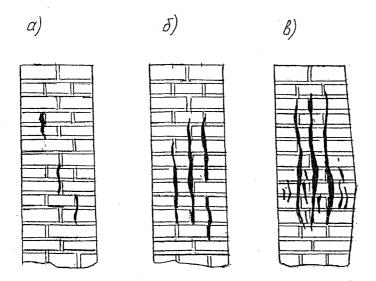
Характер развития трещин от нагрузки в сжатой кирпичной кладке
